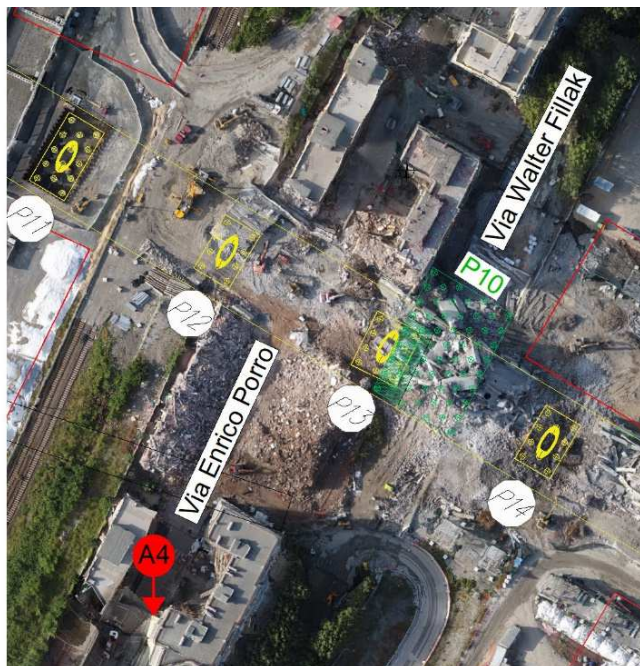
Postazione levante a Sud (44.424376 N, 8.889742 E) – PPS2 – A4
